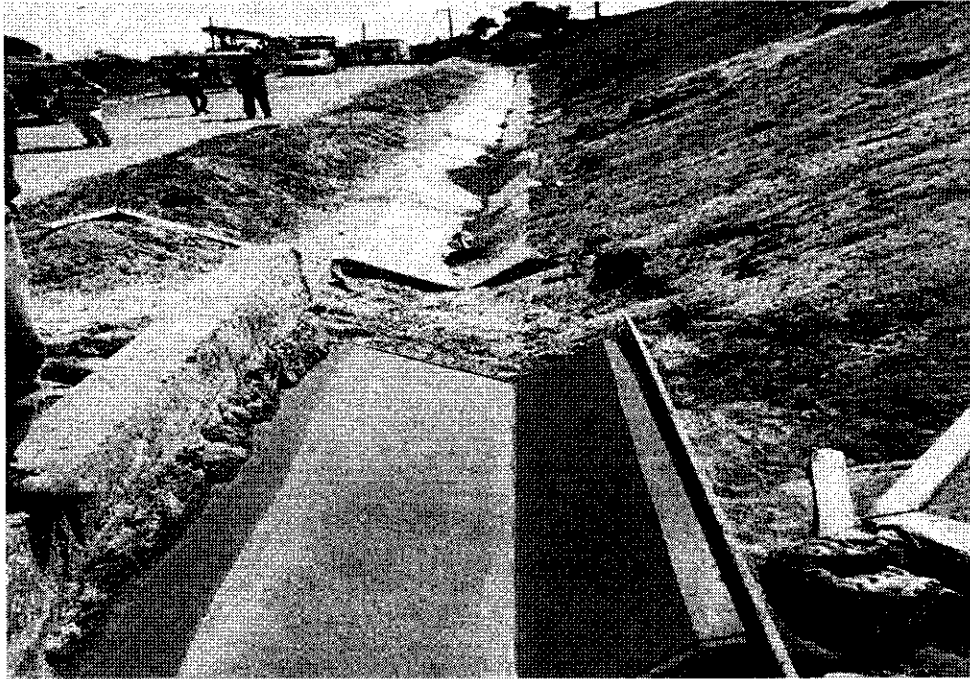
CONCRETO EN CUNETAS DE CONCRETO A PIE DE TALUD
